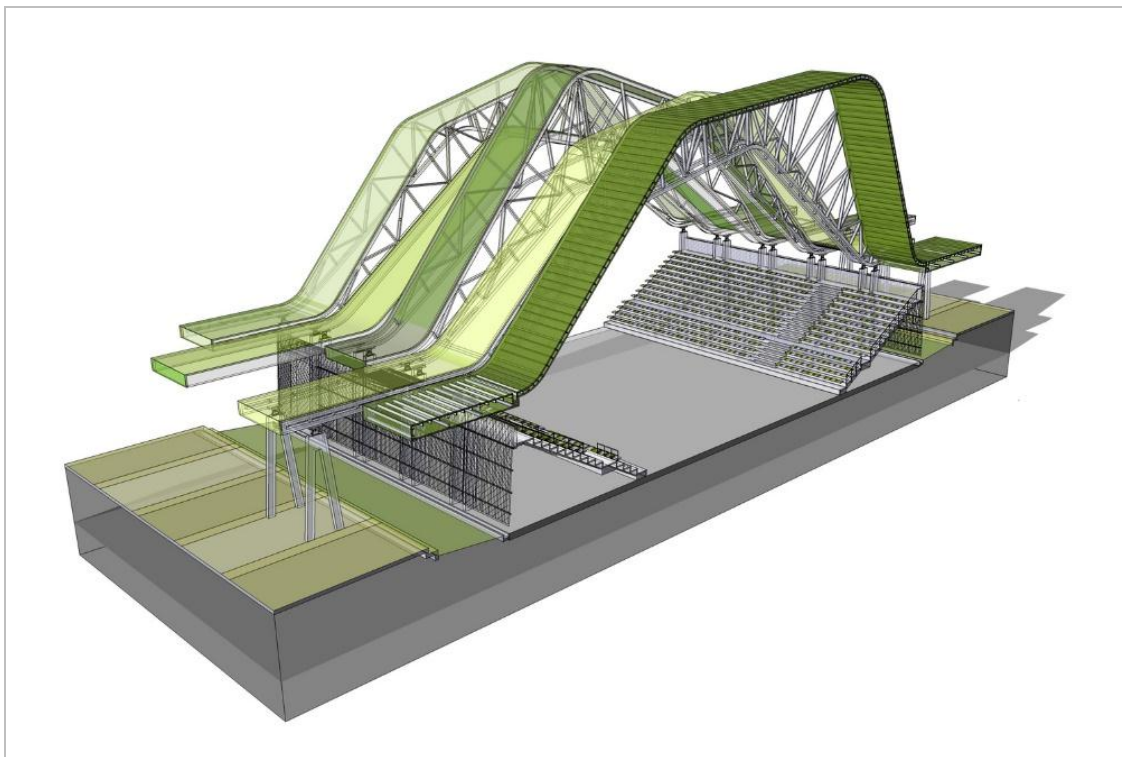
Estructura exterior de cubiertas / escenarios deportivos Medellín /Giancarlo Mazzanti
